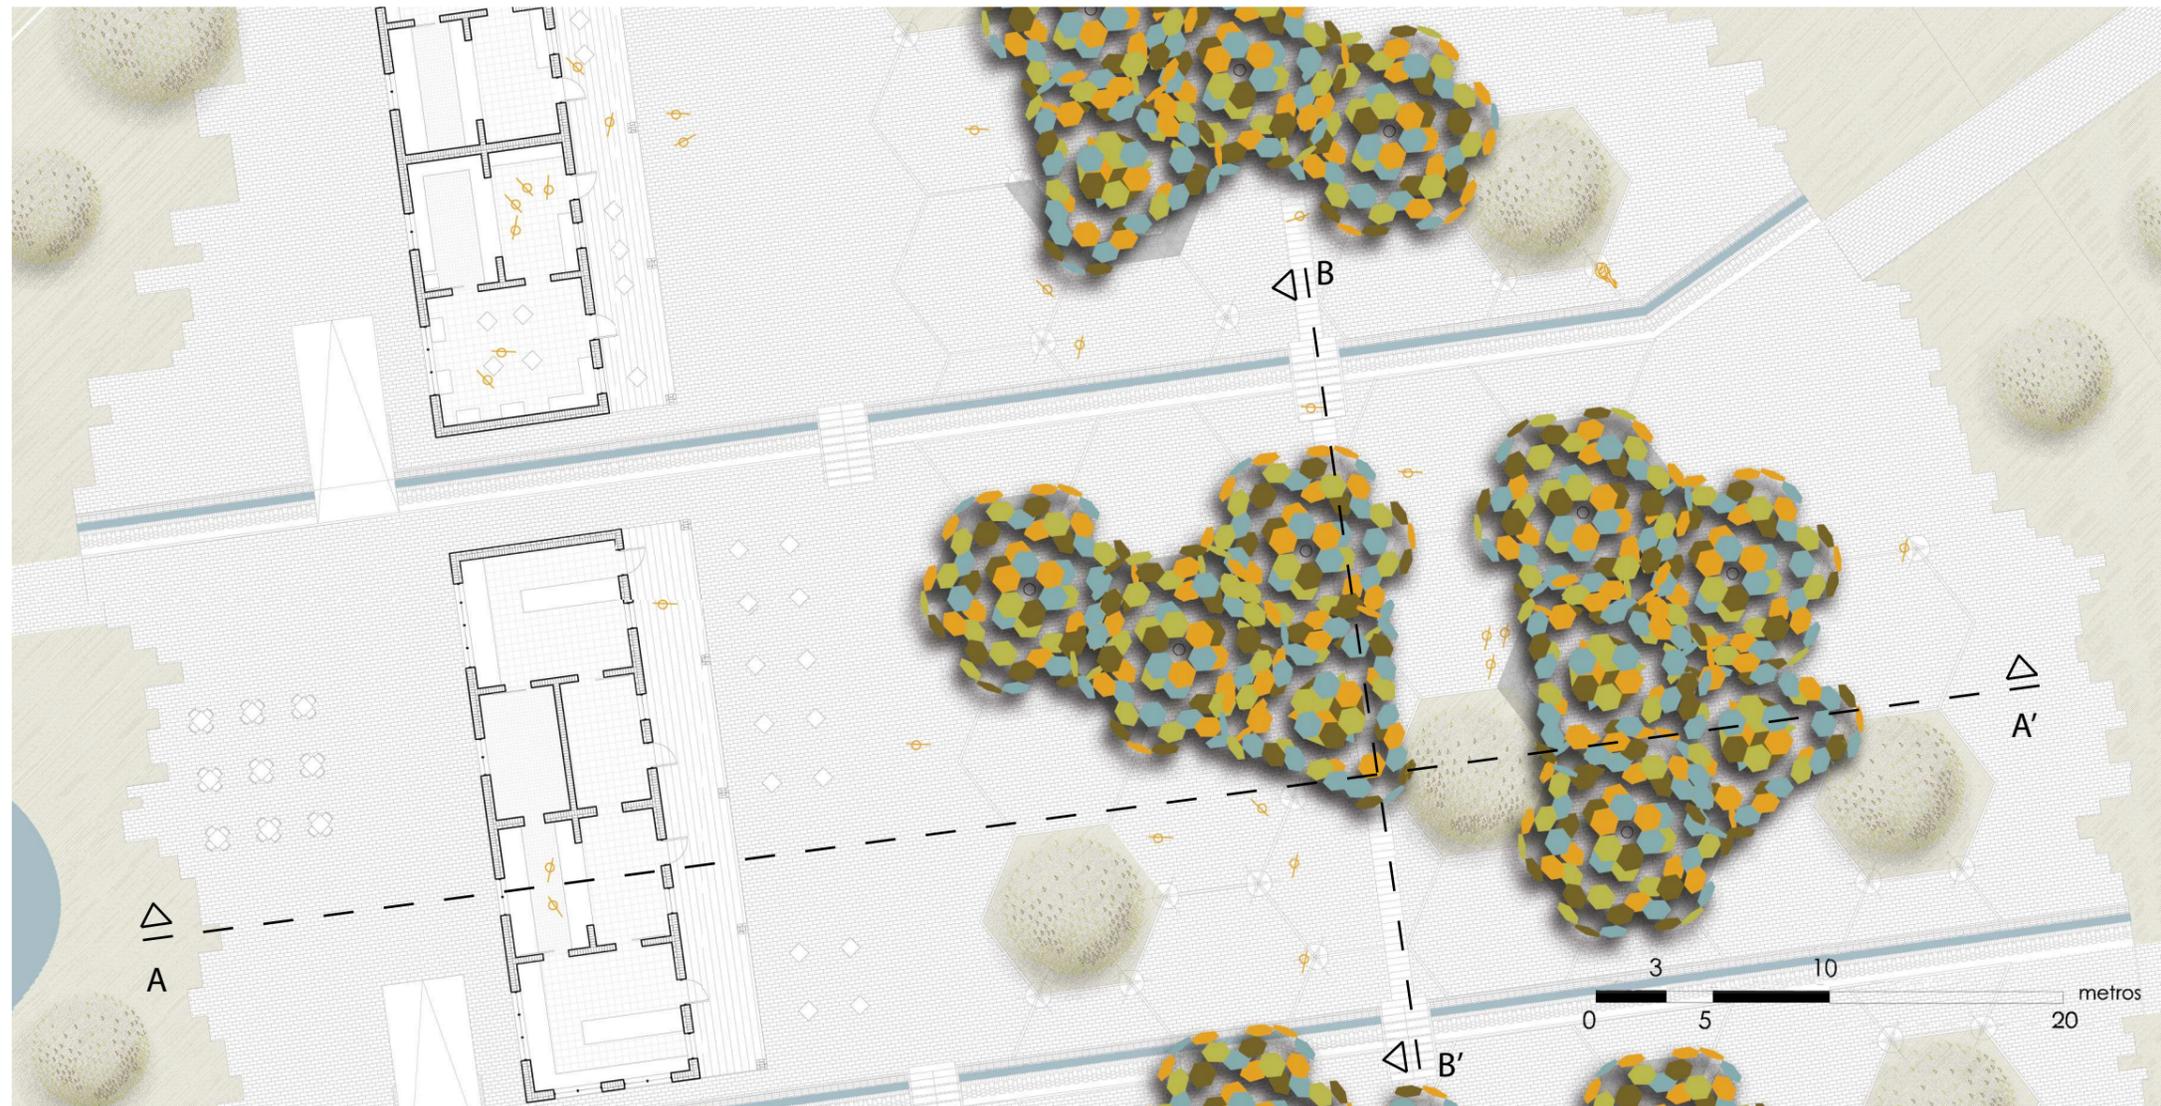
Planimetría detallada de las dos terrazas comerciales más al norte. Escala 1_300
